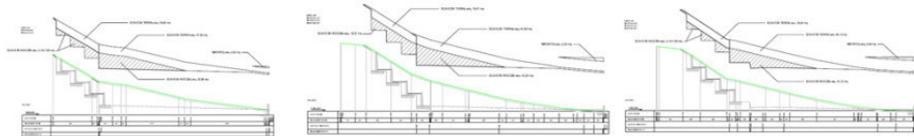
STRALCIO TAV. 17 - SEZIONI
